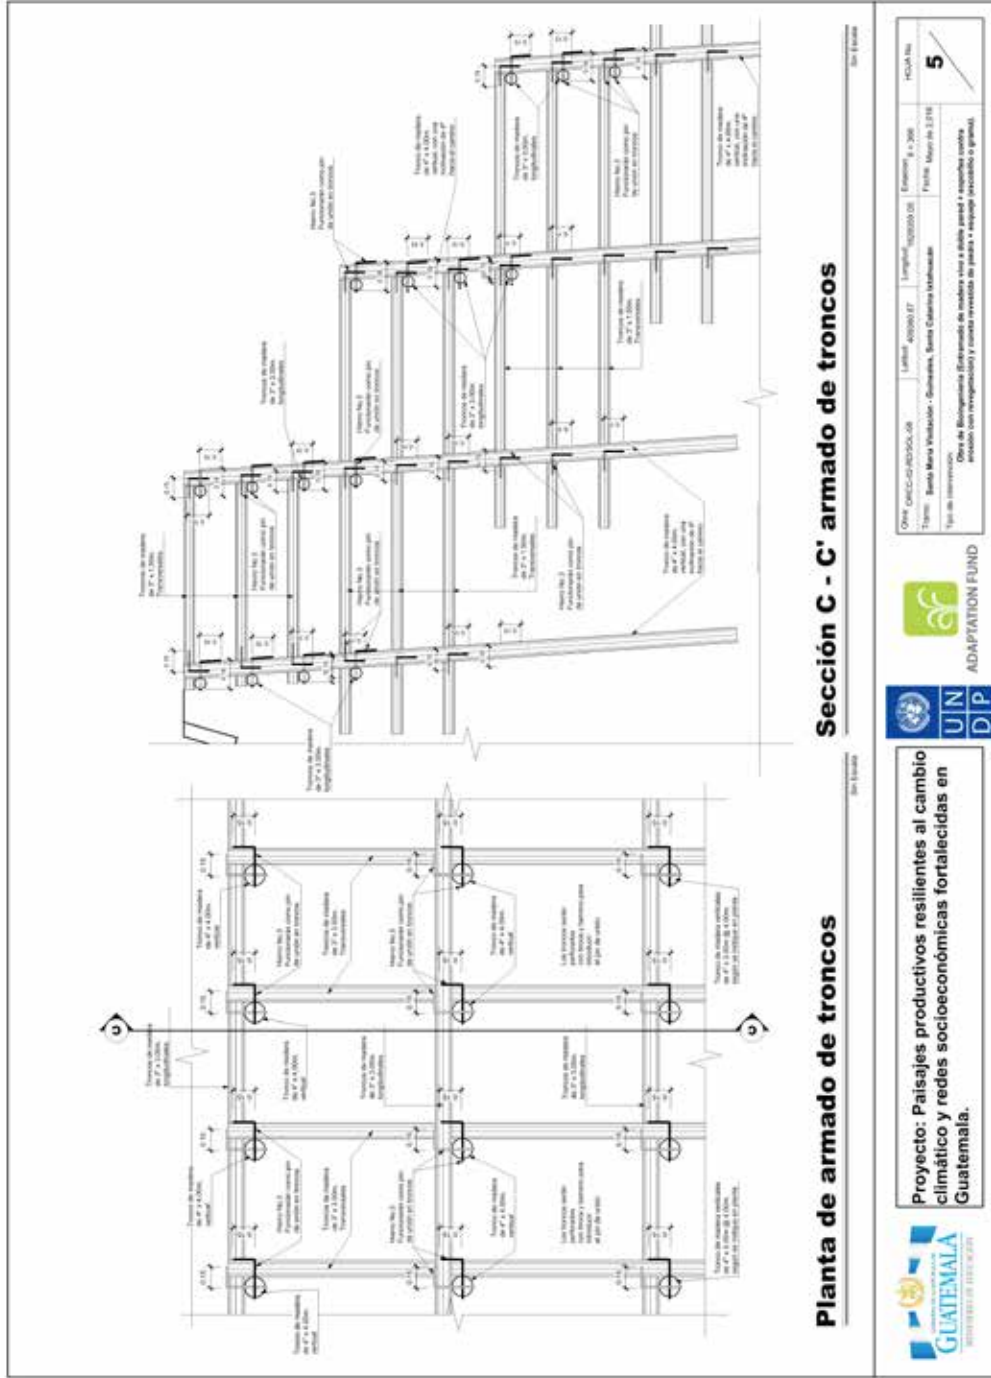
A. PLANTA DE ARMADO. SECCIÓN C-C': Planificación - Obra ORCC-02/RD-SOL-08. Tramo: (Santa María Visitación-Guineales, Sta. Catarina Ixtahuacán)
